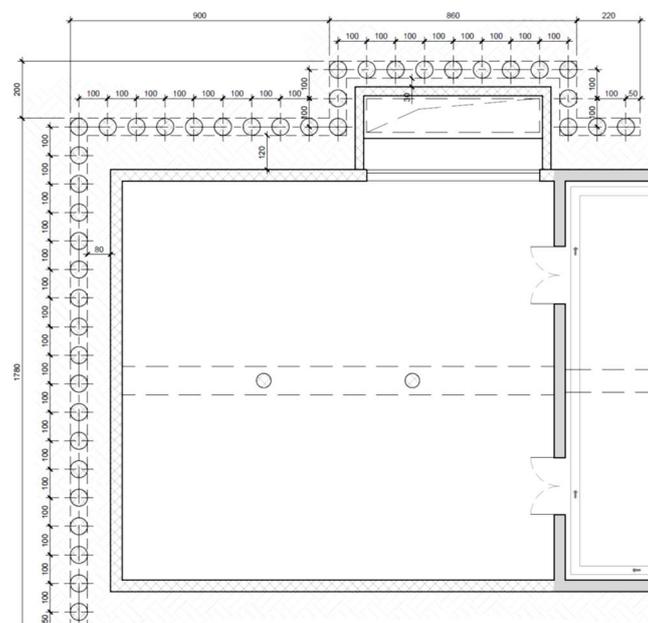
Pianta piano interrato della cantina oggetto di ampliamento
